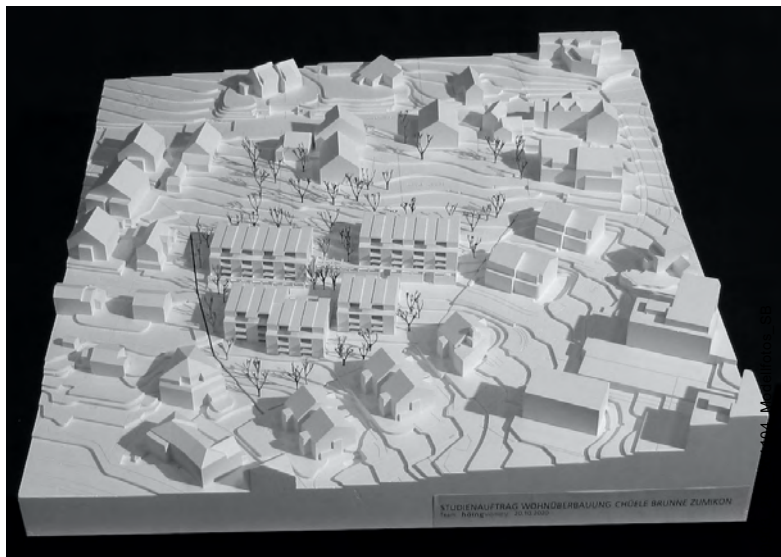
Modellfoto Projekt Höingvoney Architekten
